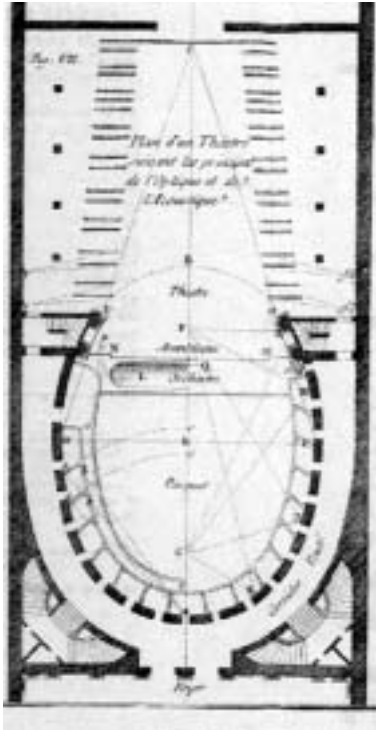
Grundriss eines barocken Theaters von Patte 1782.
